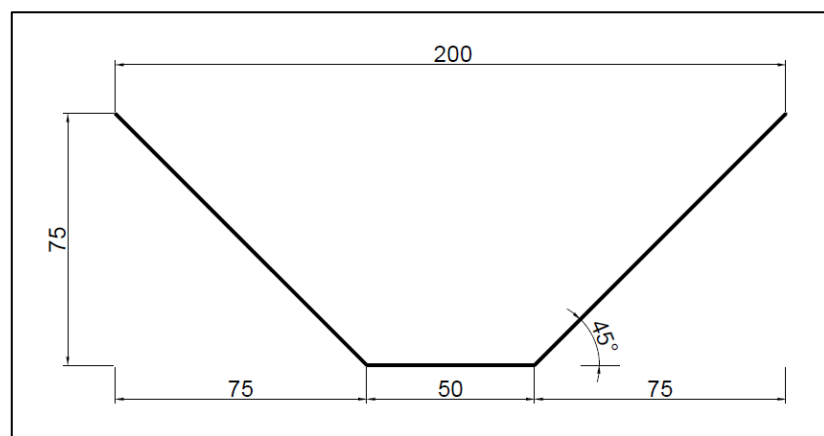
Dimensiones en centímetros de la cuneta trapezoidal propuesta. Fuente: elaboración propia.
